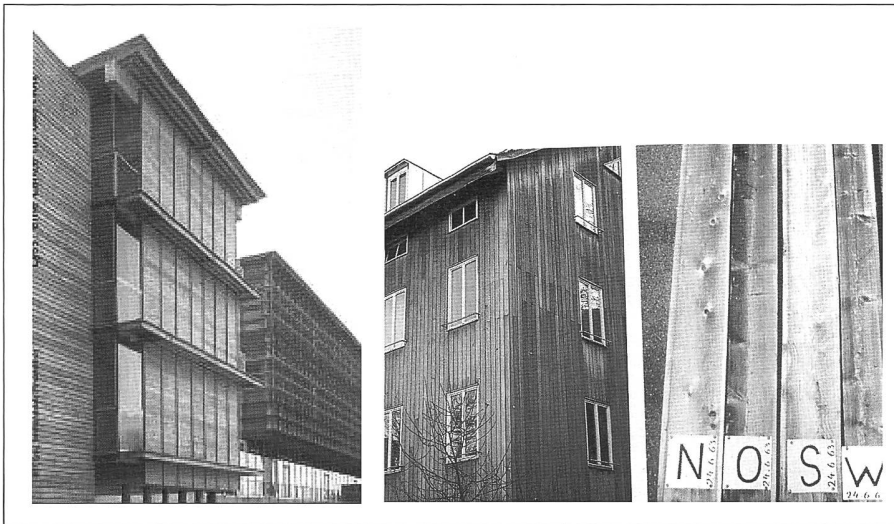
Holzbauten mit unbehandelter Fassade.
